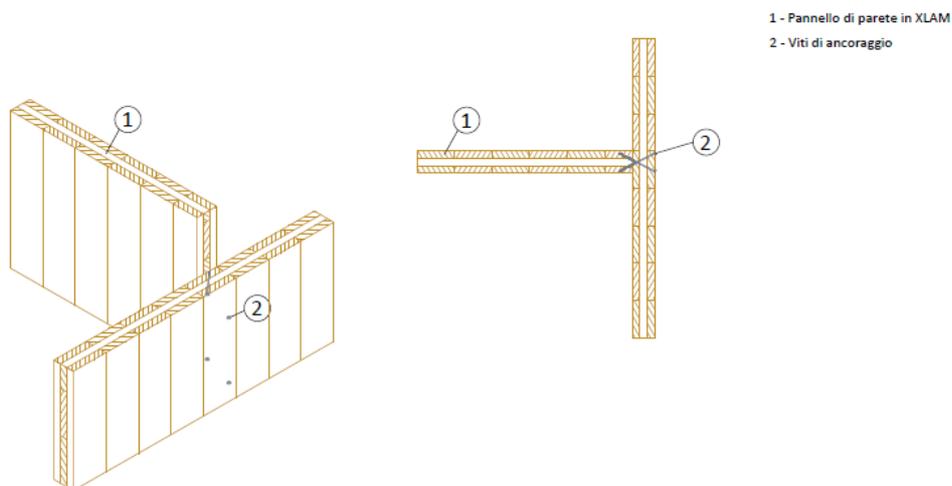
Collegamento parete-parete d'incrocio tramite viti di ancoraggio
